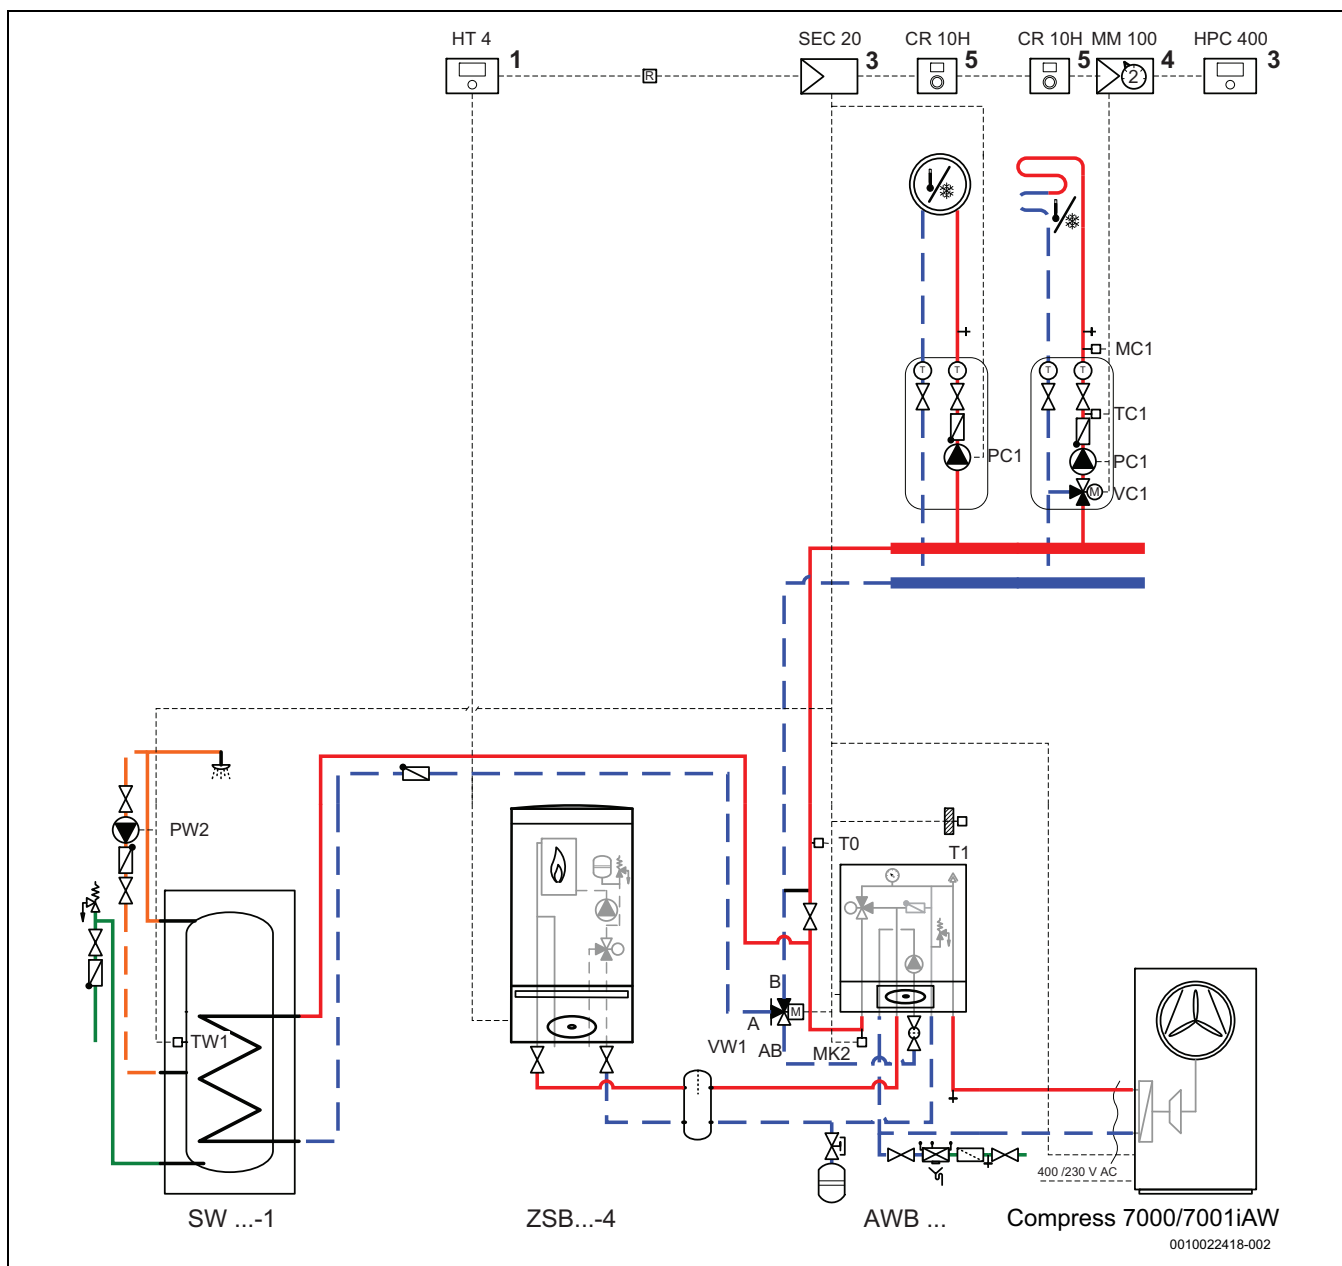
Дополнительный нагреватель со смесителем и с баком-водонагревателем
